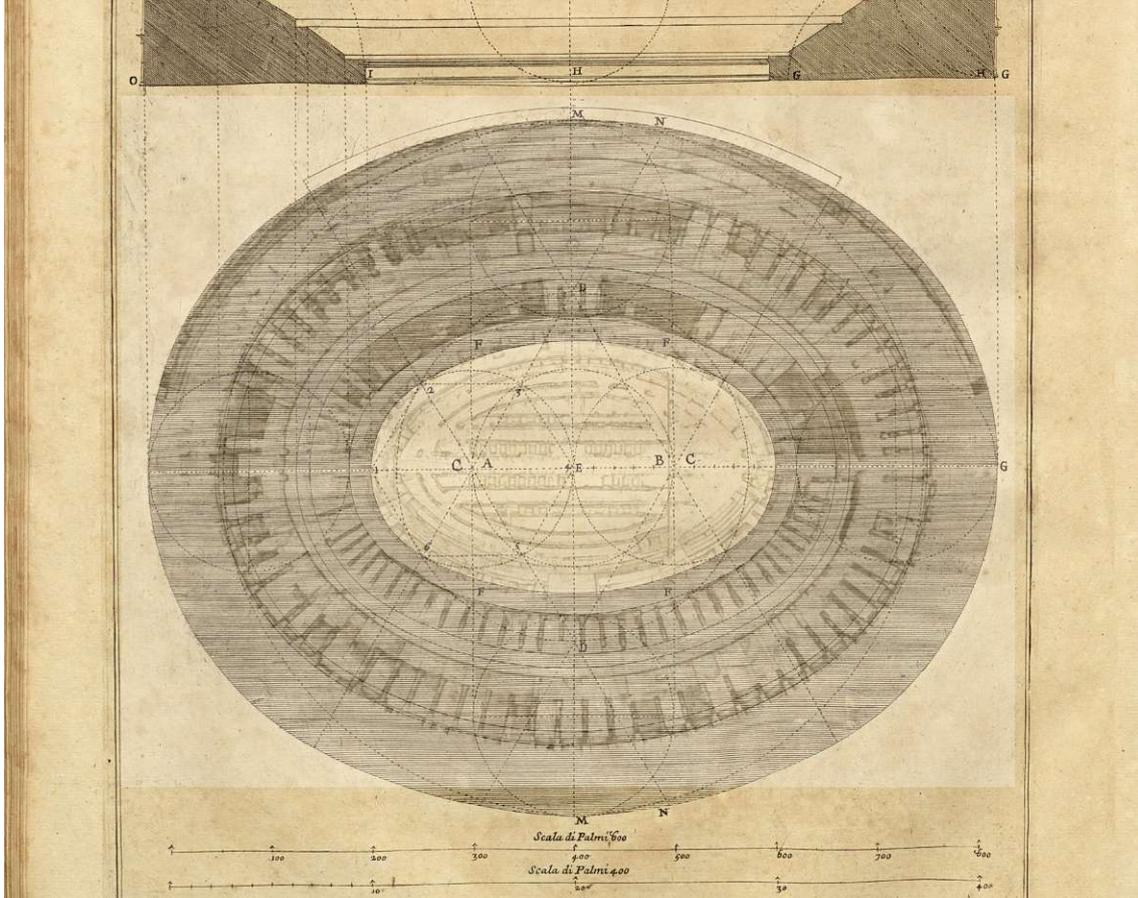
Überlagerung von Carlo Fontanas Konstruktionsweise und dem tatsächlichen Grundriss des Kolosseums
